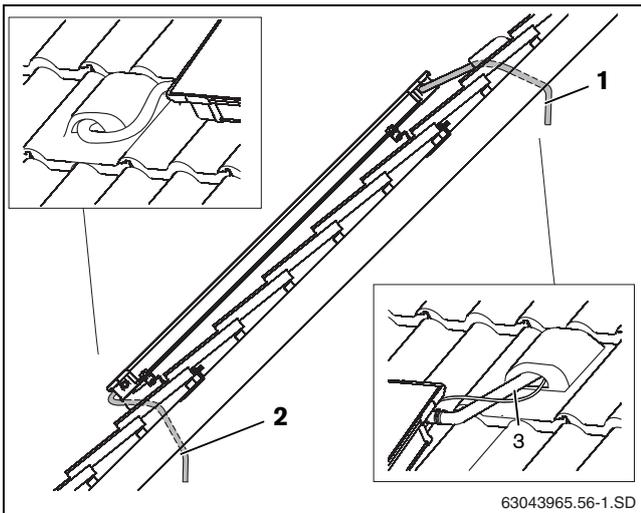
Sistemazione delle tubazioni di allacciamento sotto il tetto
